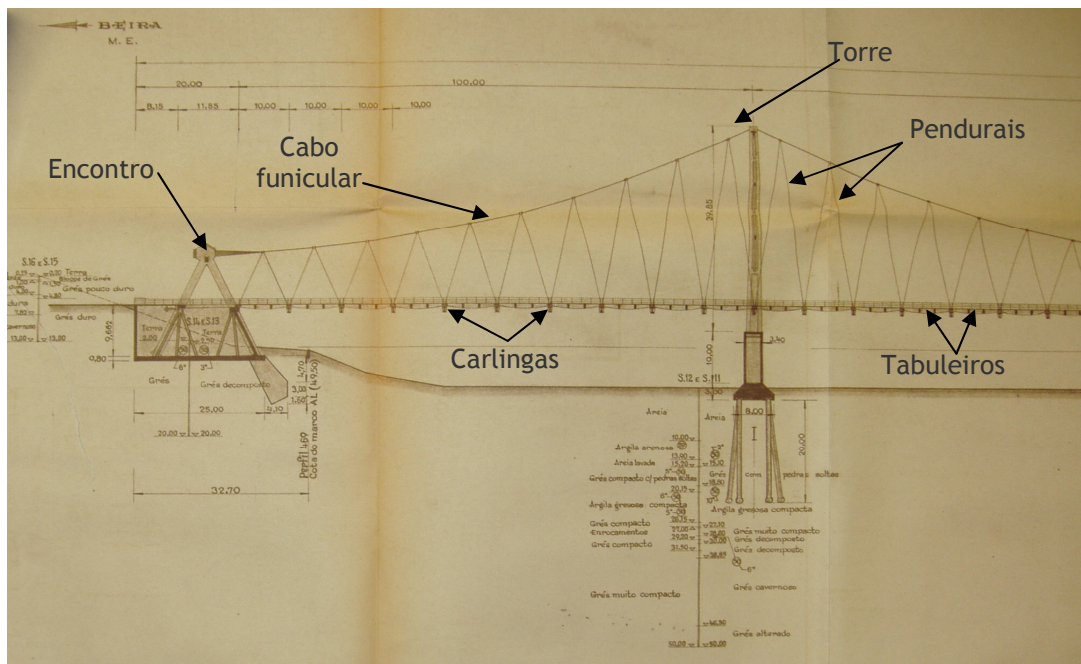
localização dos elementos estruturais da ponte sobre o rio Save, Cardoso, Edgar (1963)
